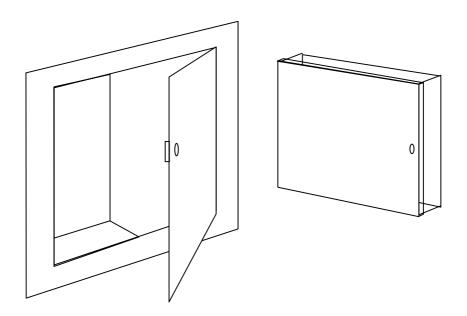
Внешний вид и варианты исполнения Этажного прибора
